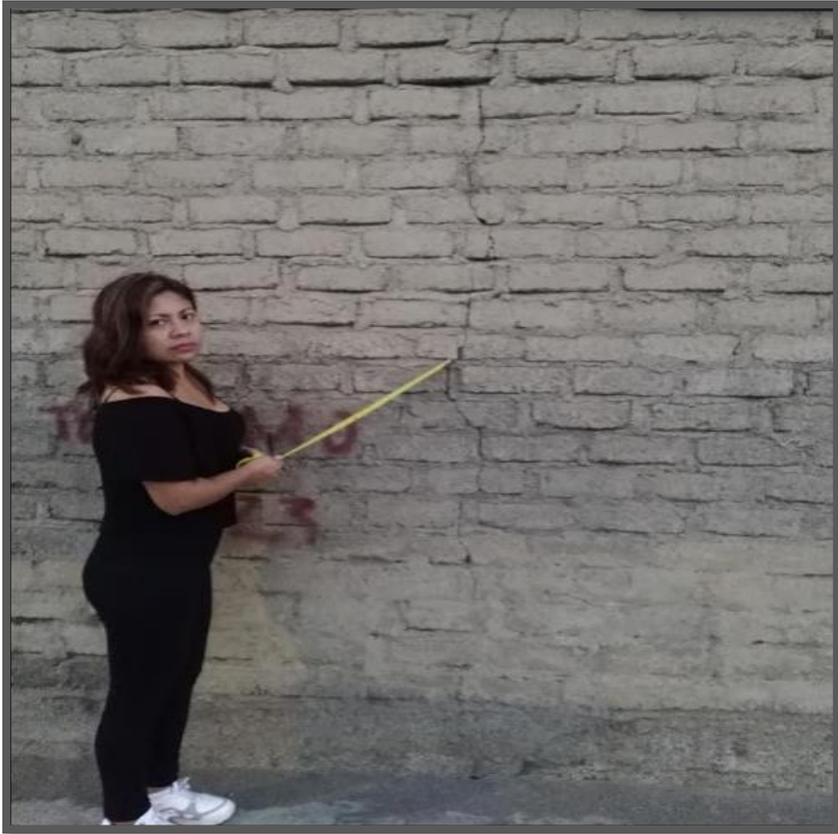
Muro afectado por grieta en la unidad de muestra 15
